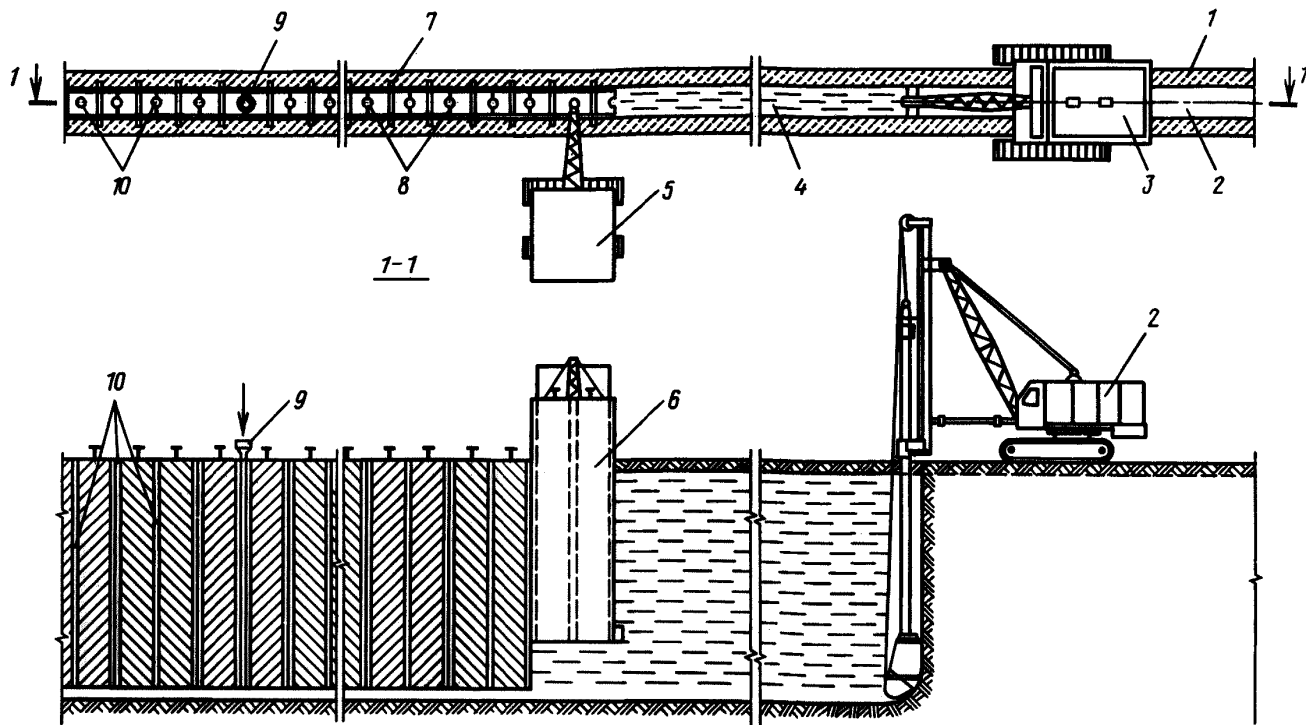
Устройство сборной "стены в грунте" при непрерывной разработке траншеи:
